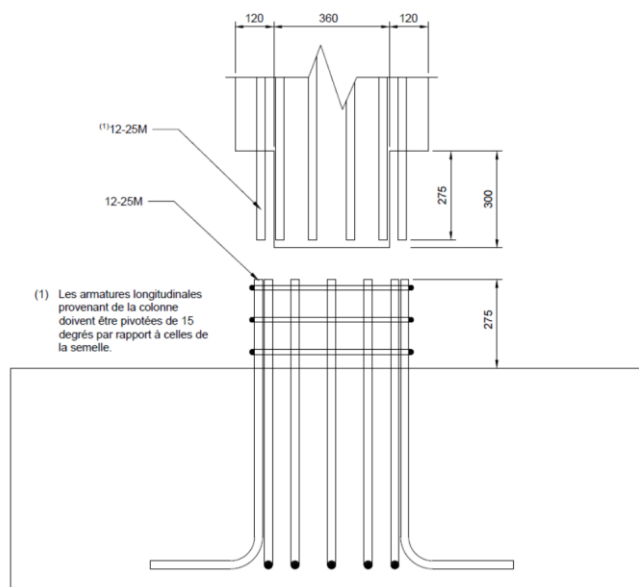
Géométrie du joint de la colonne préfabriquée à la semelle (Darveau, 2018)
